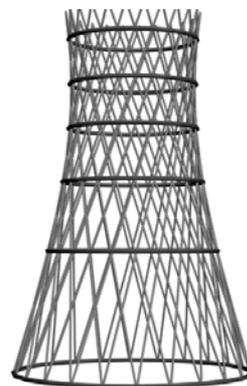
Основа конструкции башни - однополостной гиперboloид.
